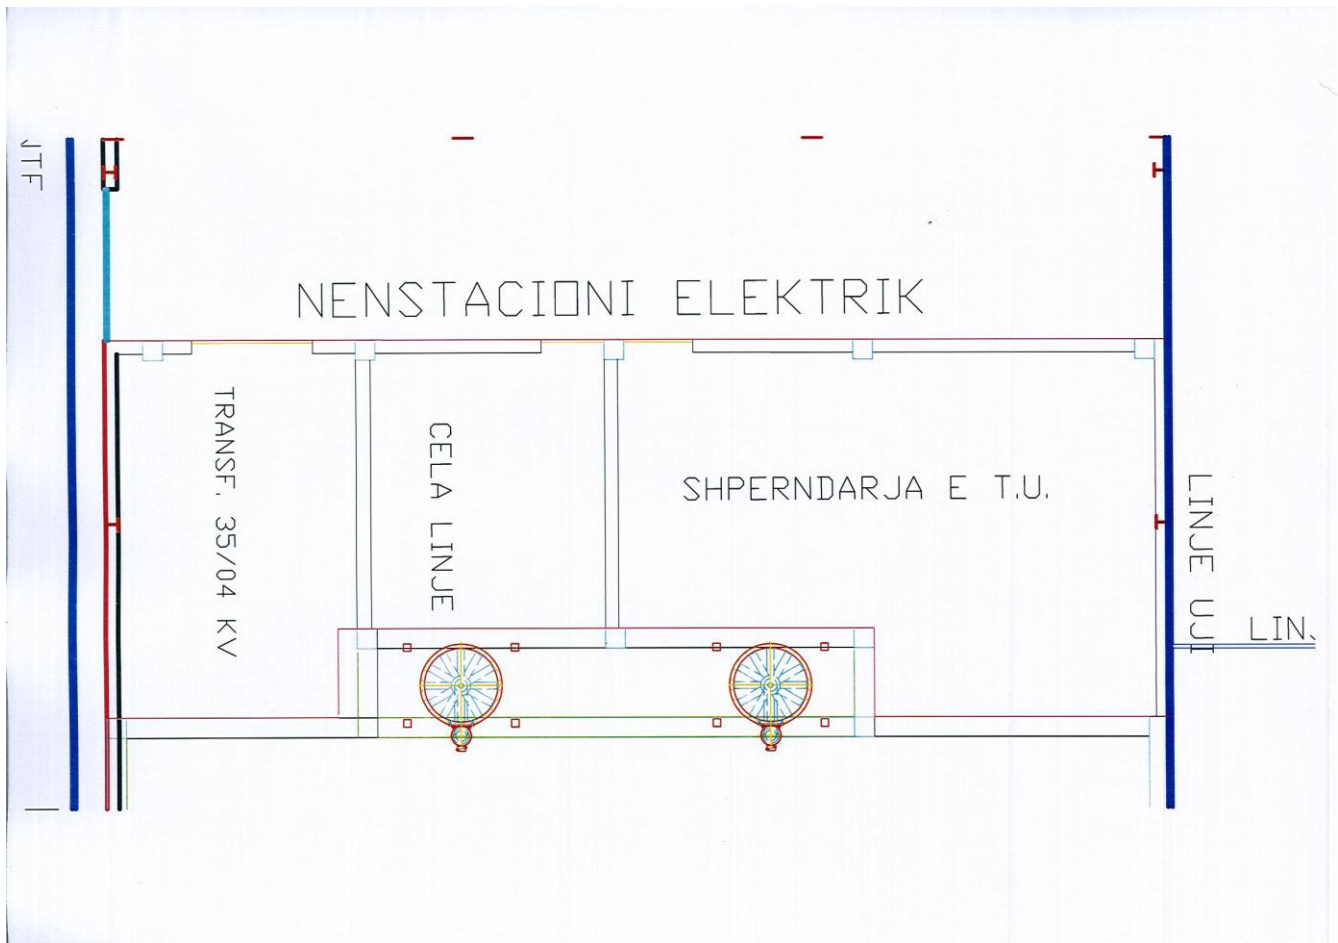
Te dhena te planimetrise se nenstacionit elektrik
